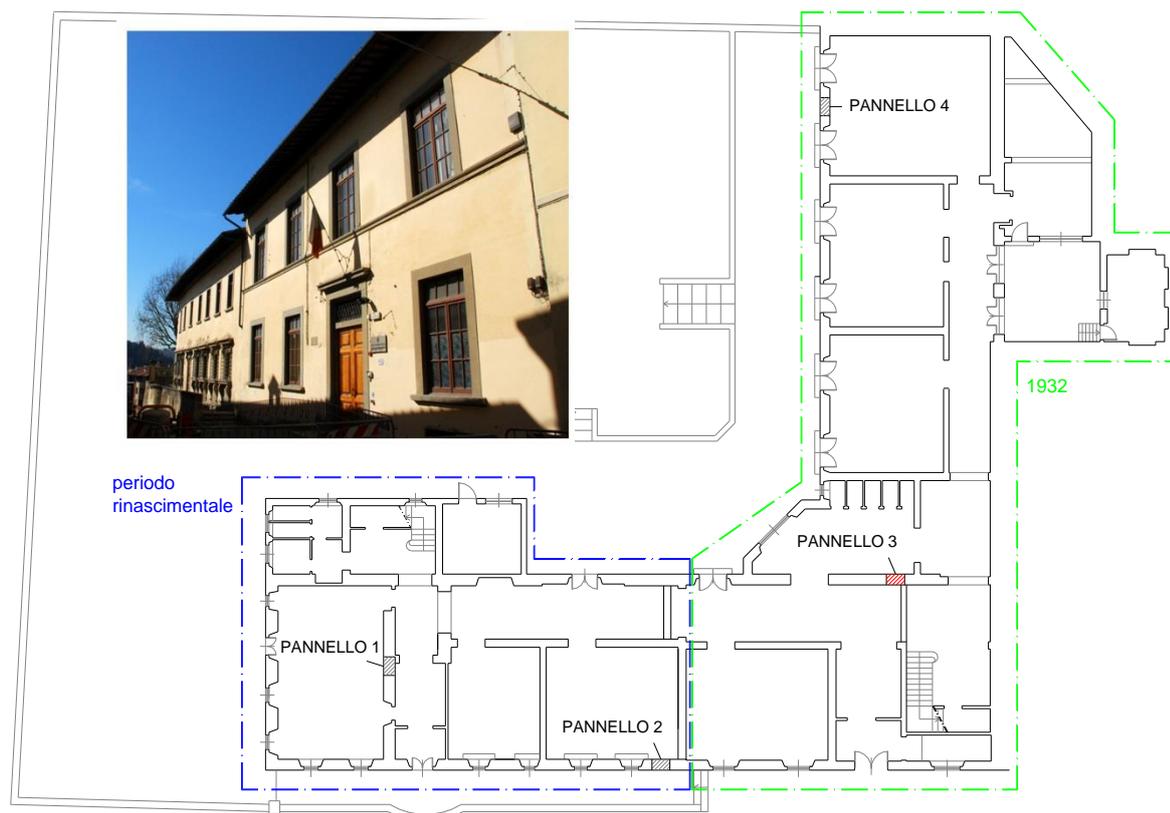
Pianta e prospetto; individuazione dei pannelli murari e fasi di costruzioni storiche dell'edificio.
